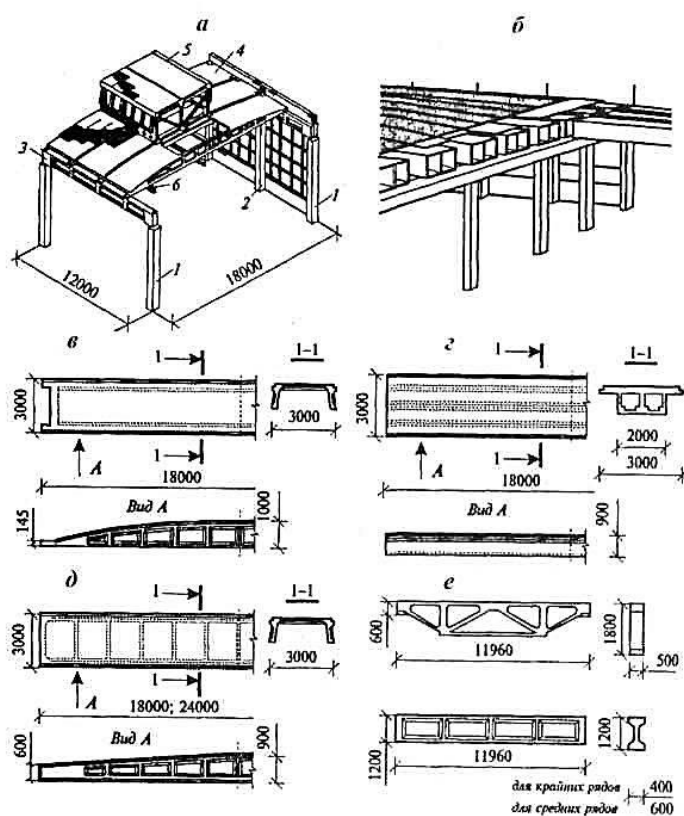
Конструкции покрытия с плитами «пролет»:
